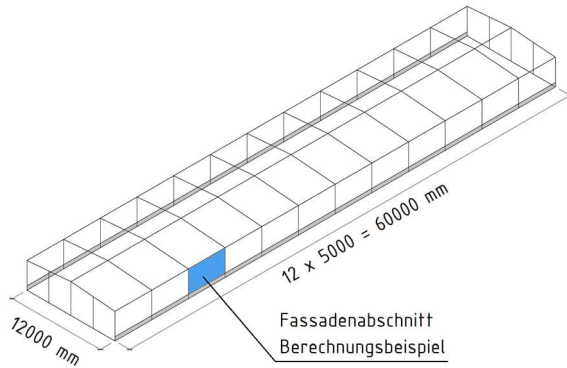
Geometrie der Stahlhalle und Fassadenabschnitt für das Berechnungsbeispiel
